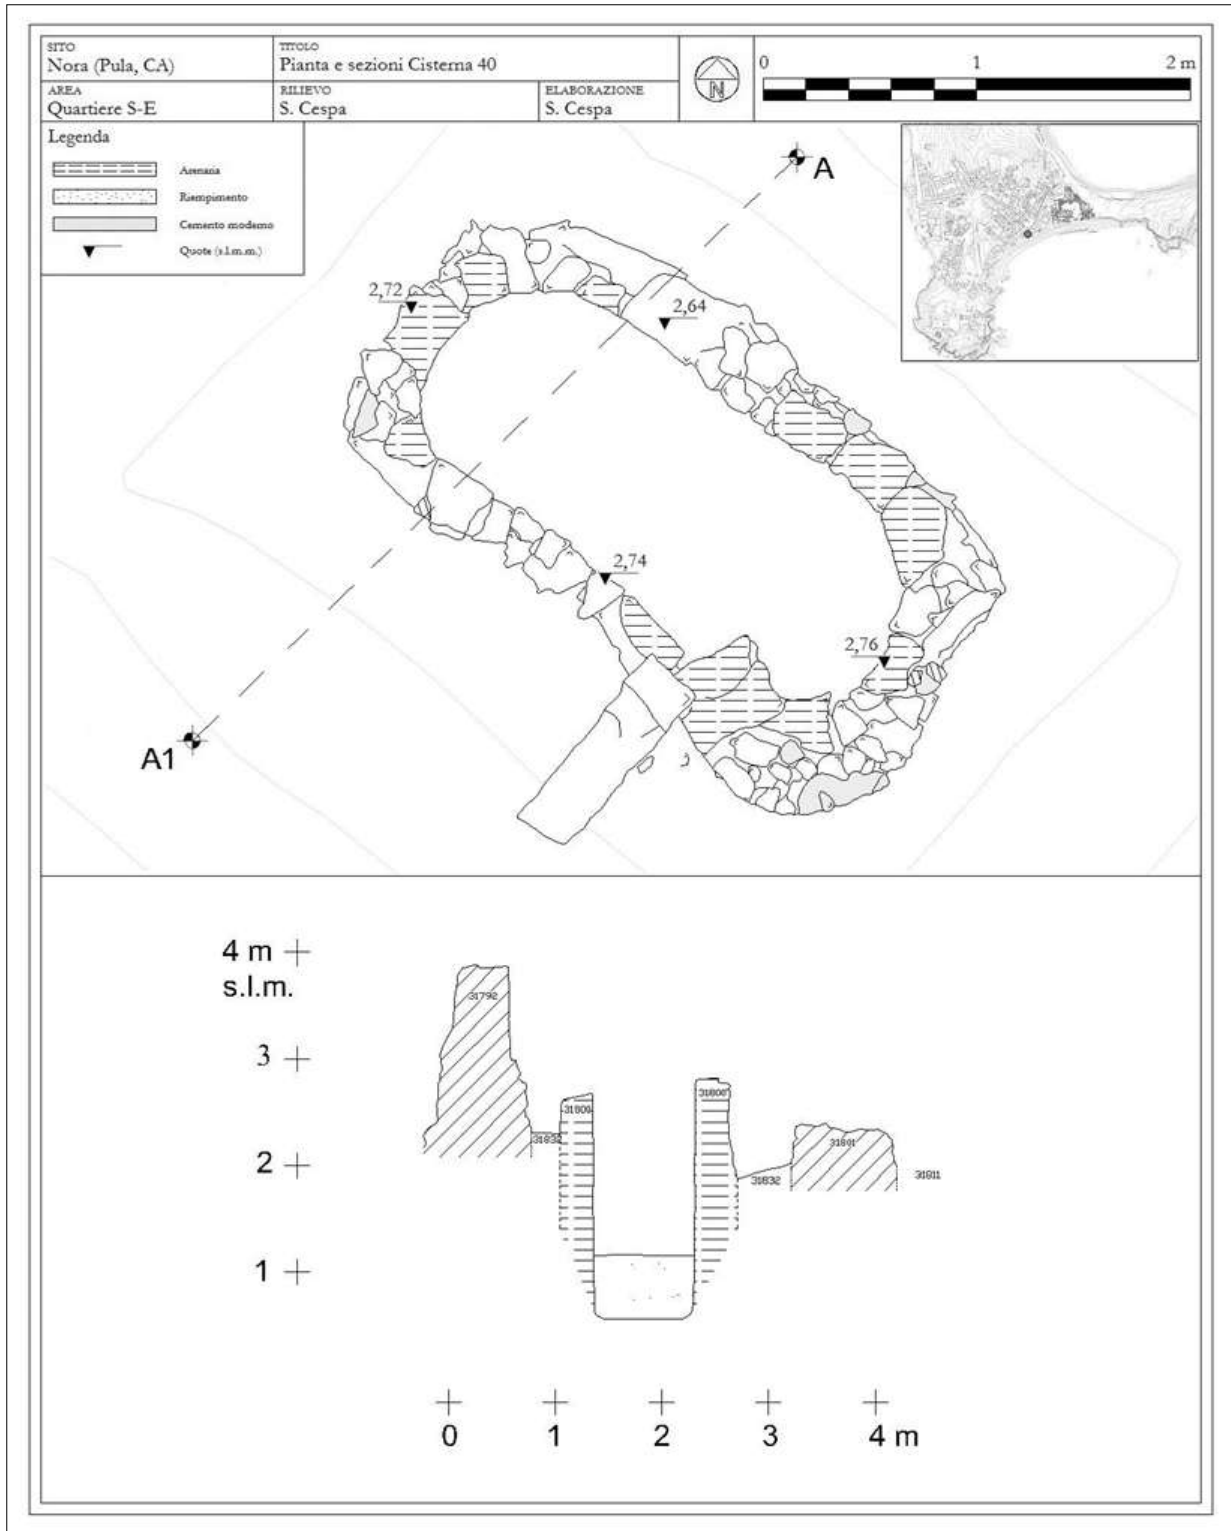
Pianta e sezione della cisterna 40 (elaborazione dell'autore).
